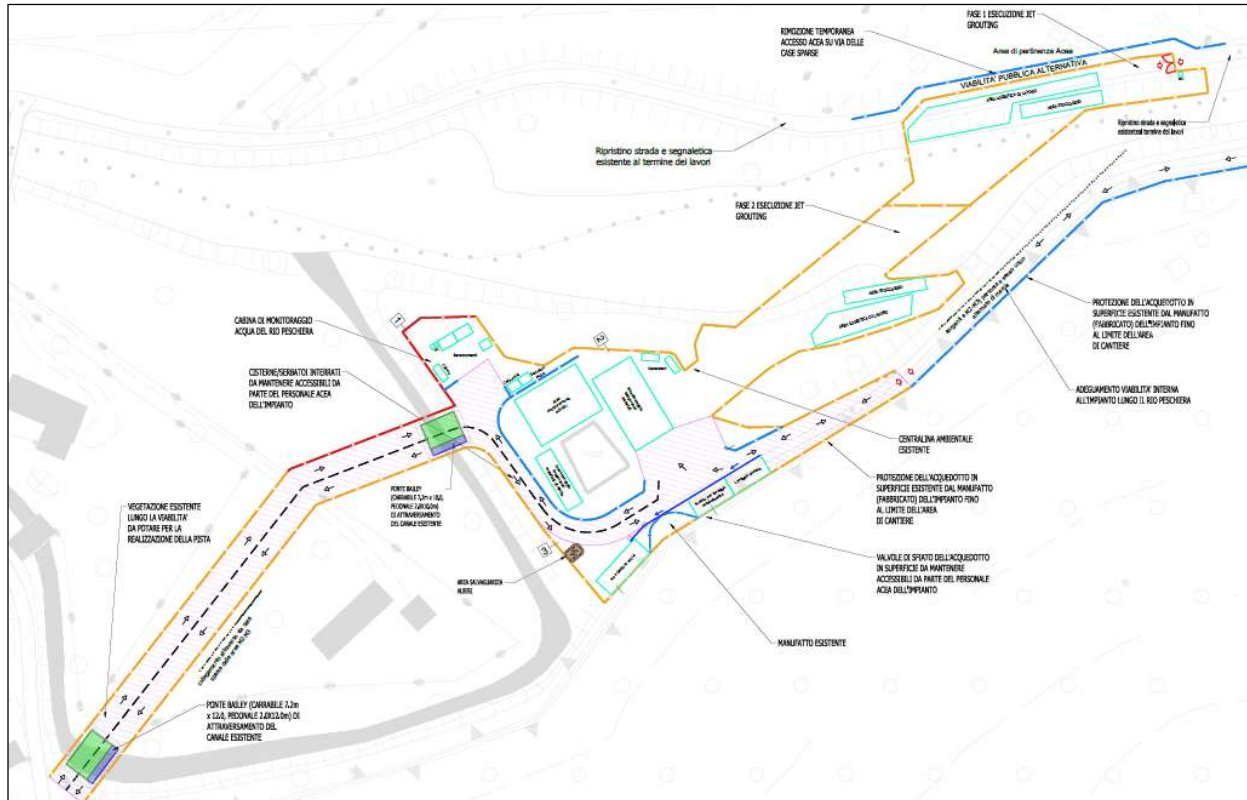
Area di cantiere M2 e Area attraversamento Rio Peschiera
